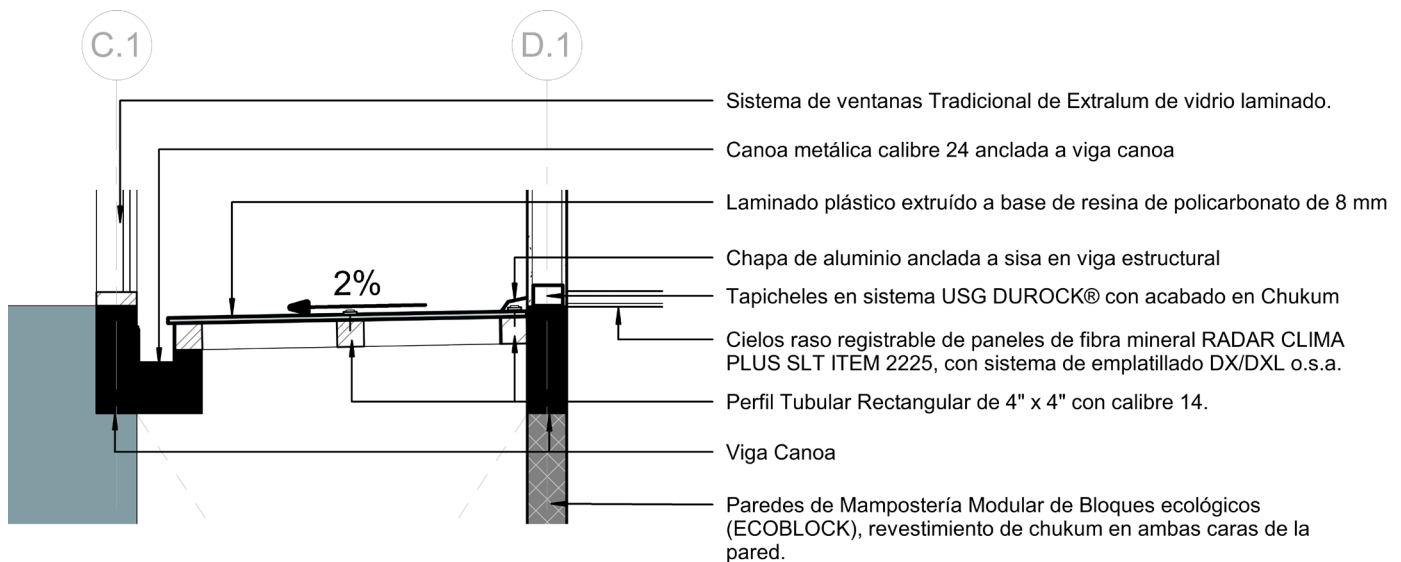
Detalle de Lucernario. Fuente: Elaboración propia
